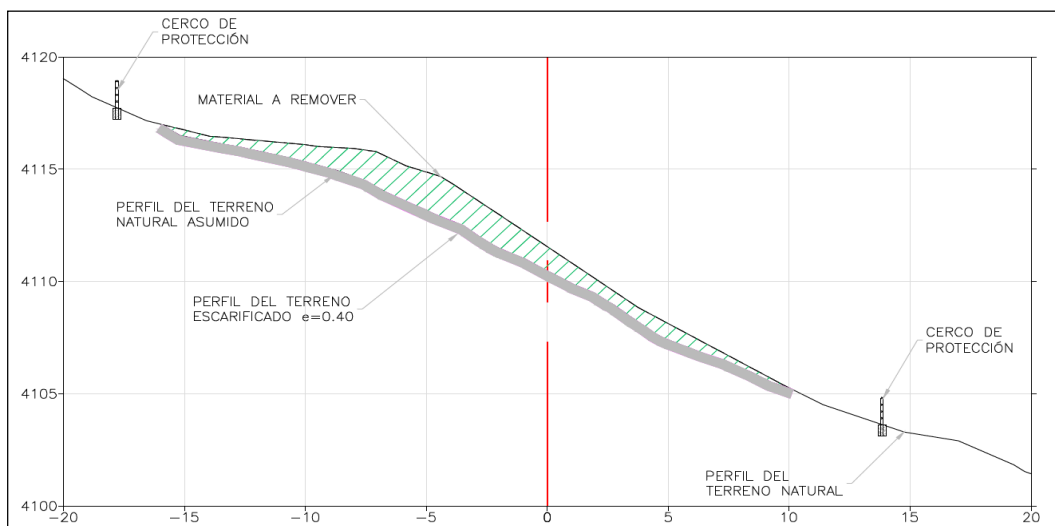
Sección típica de remoción y perfilado desmonte mina
